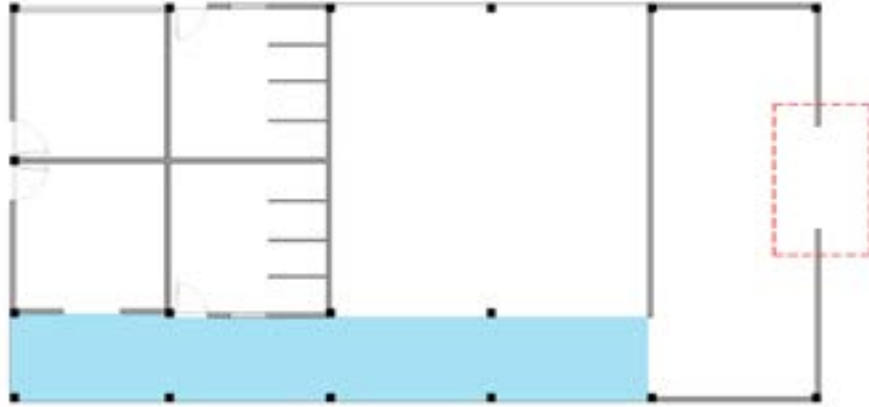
Planta esquema circulaciones Bloque No.20.
